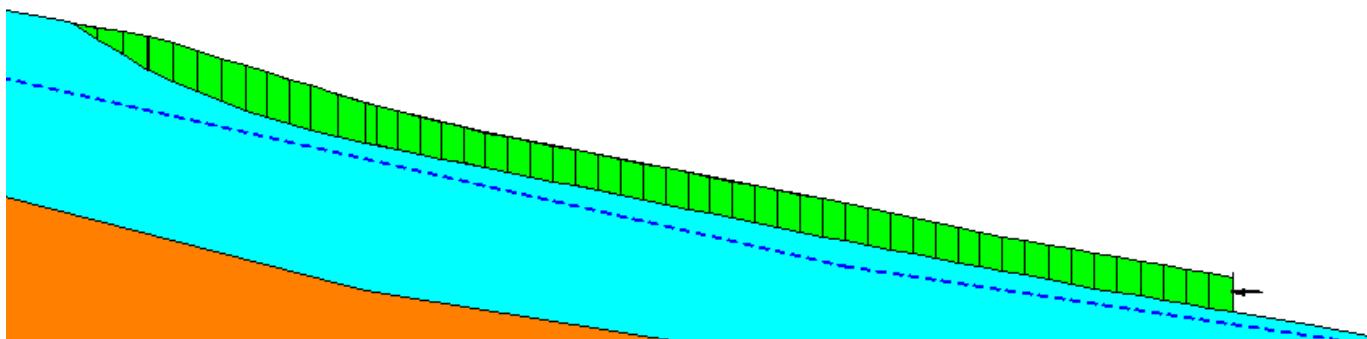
Sezione 1 – Valutazione forza stabilizzante
